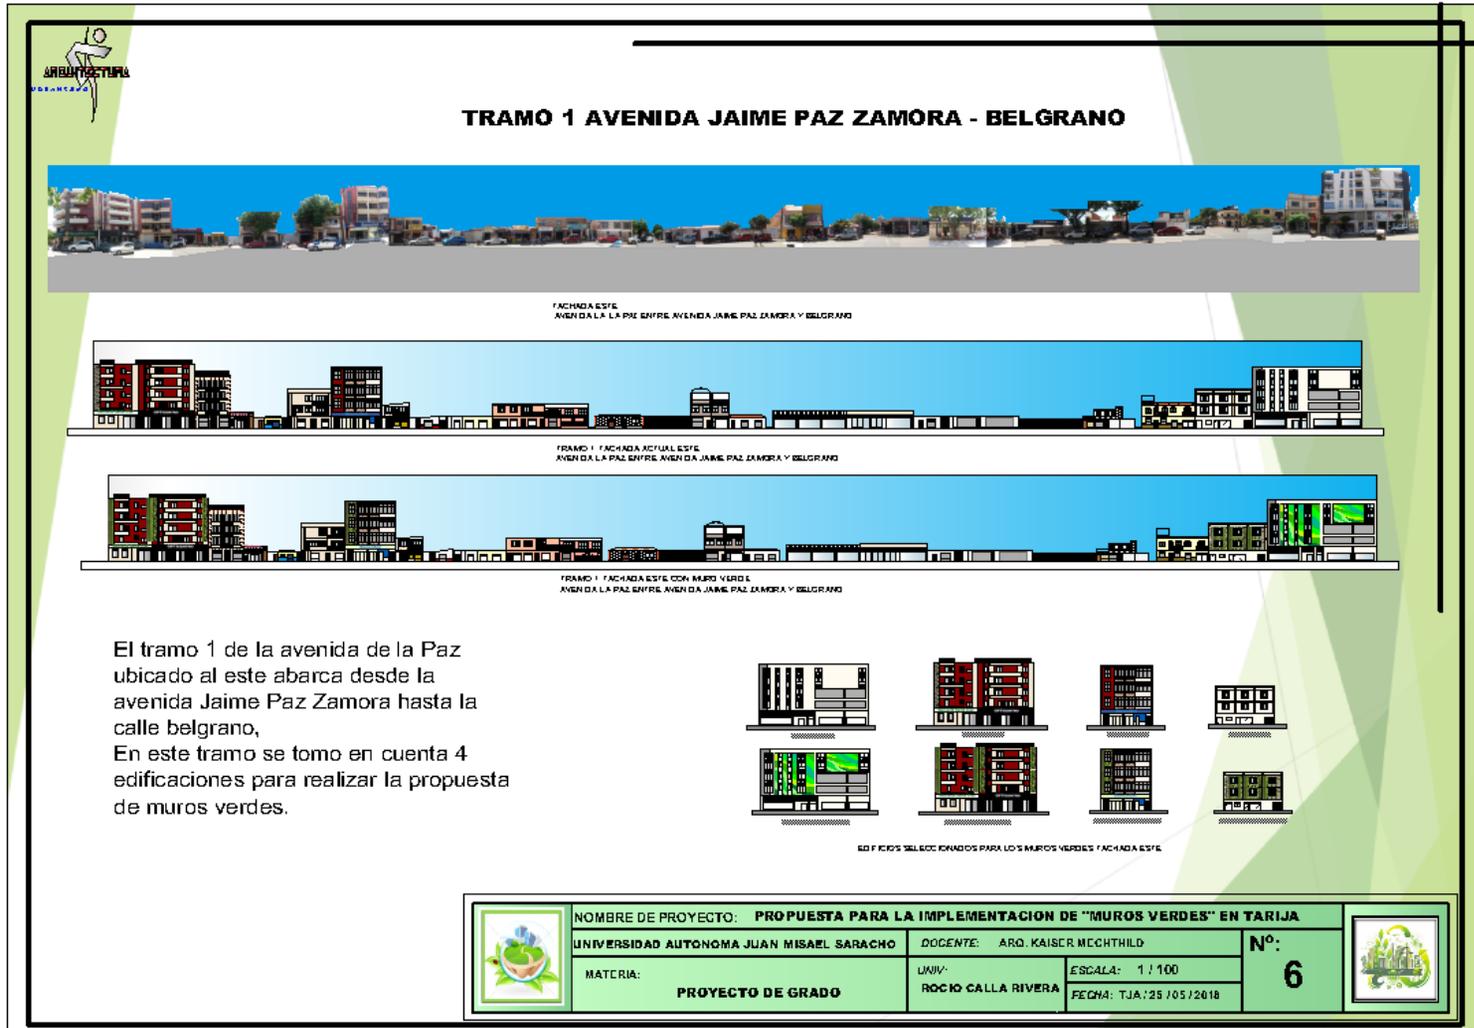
Plano tramo 1 Jaime Paz Zamora
